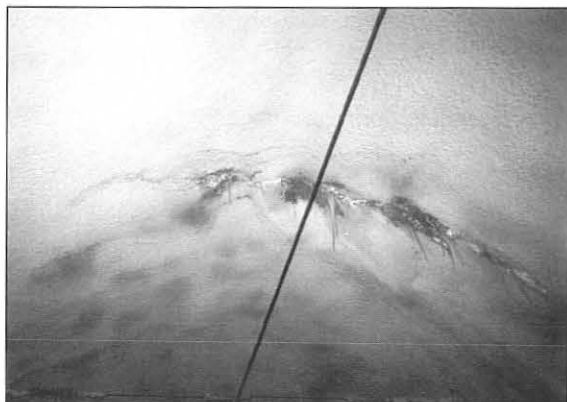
Risse im frisch sanierten Rufenen-Tunnel
